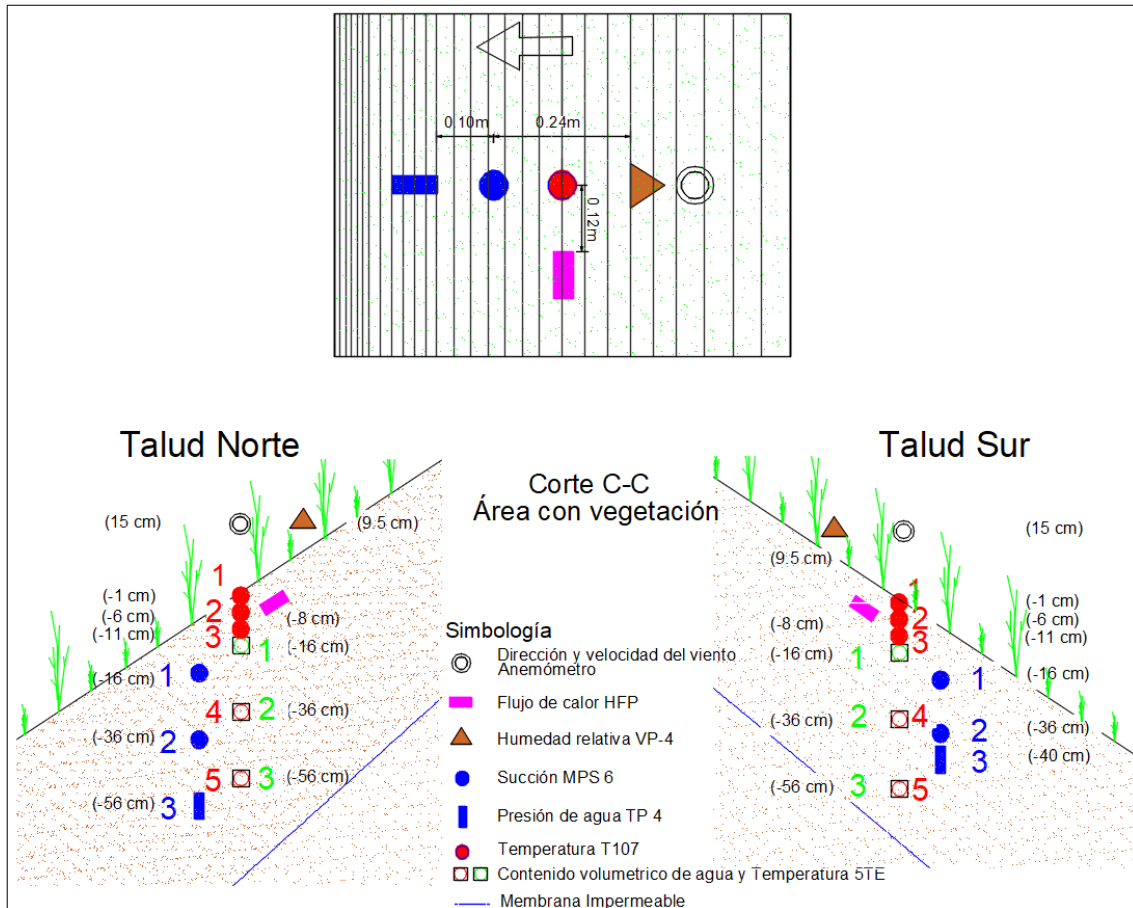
Ubicación de sensores en planta y perfil del área con vegetación (perfil C-C)
